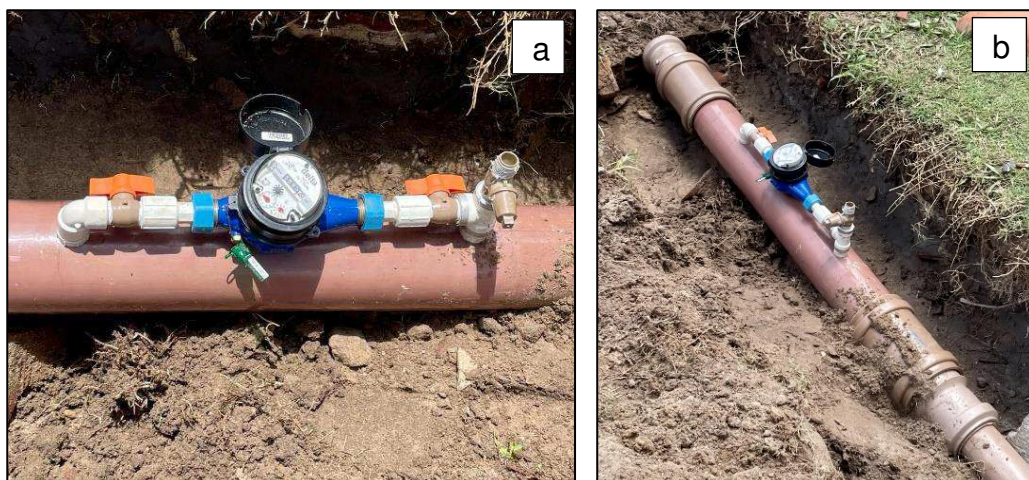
Trecho reto da tubulação com instalação de hidrômetro de derivação.
